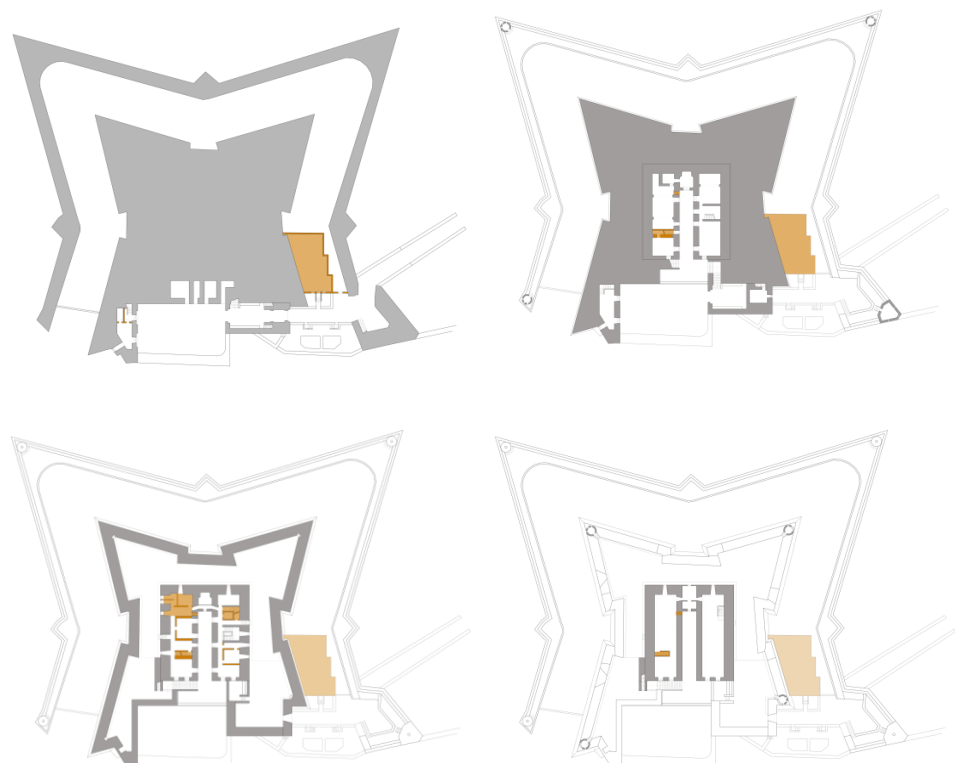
| Plantas de levantamento dos vários pisos do Forte com indicação a amarelo das demolições e alterações propostas
